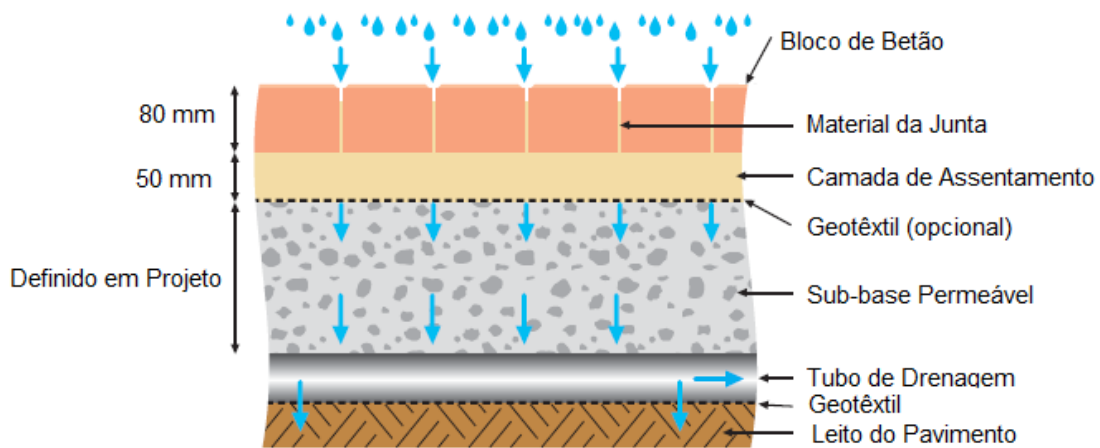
Pavimento permeável tipo B – Infiltração parcial (INTERPAVE, 2010)
